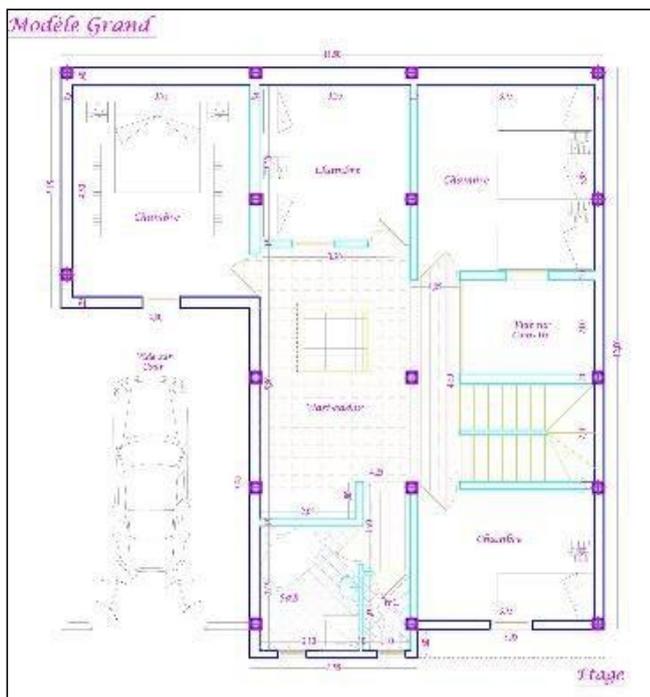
plan d'étage du type grand. Source : fondation amidoul
